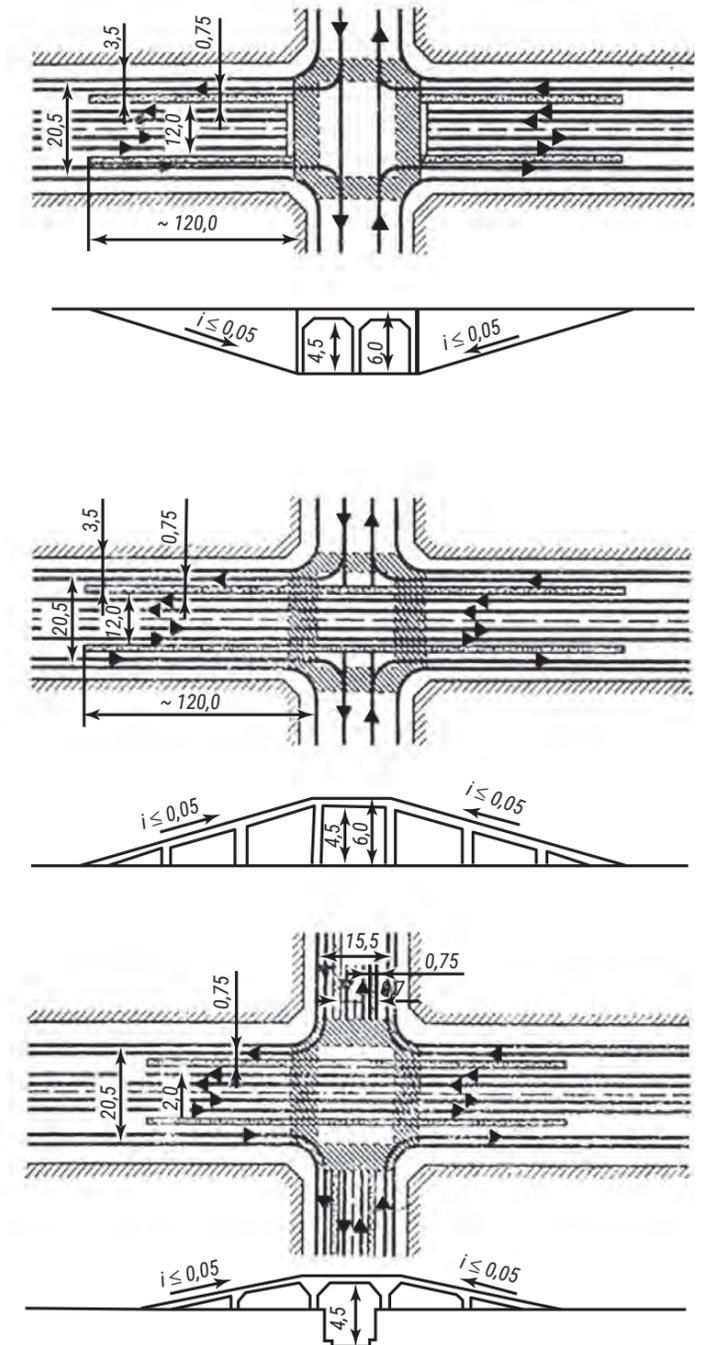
Варианты высотного решения транспортных развязок автомобильных дорог: а — тоннельное пересечение; б — путепроводное пересечение; в — комбинированное пересечение
